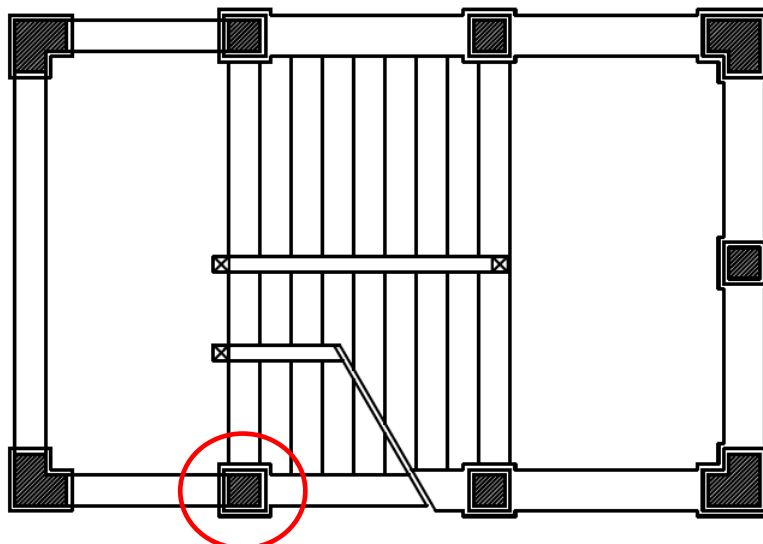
Pianta della scala del primo piano e individuazione del pilastro su cui è avvenuto il sondaggio,
